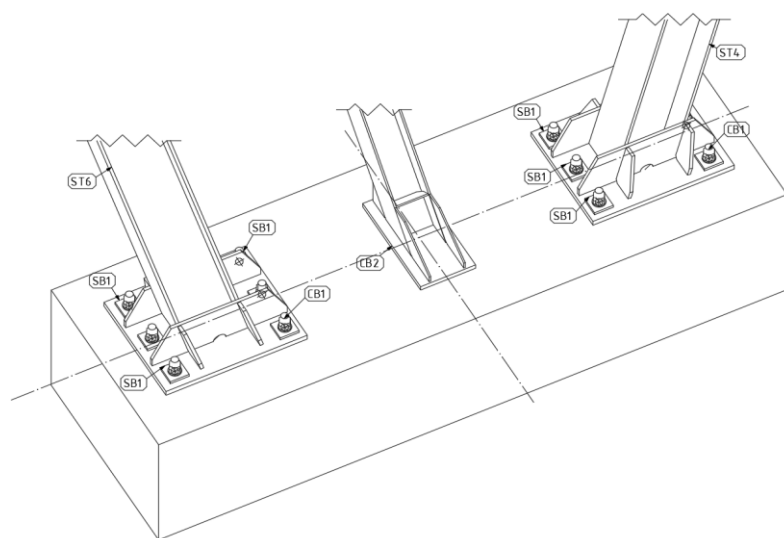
Detaliu conexiune stâlp metalic-fundație beton armat
